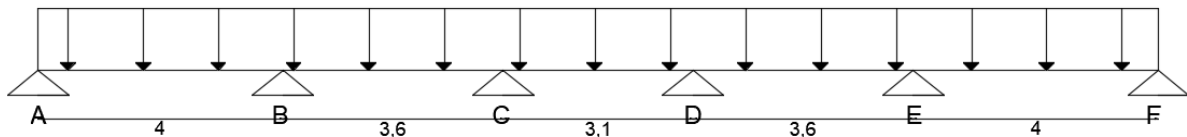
Schéma statique d'une poutre reposant sur 6 appuis à l'ELU
